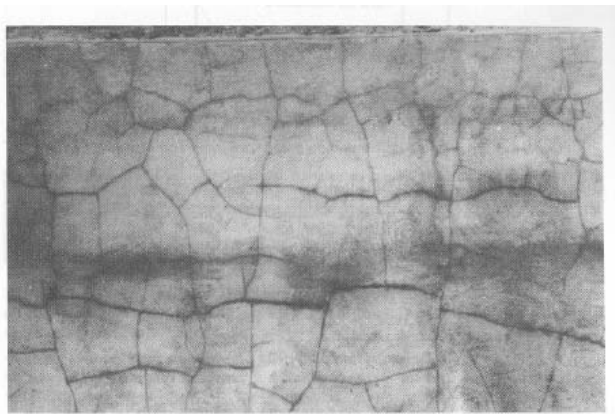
Fissuras características de dessecação superficial
